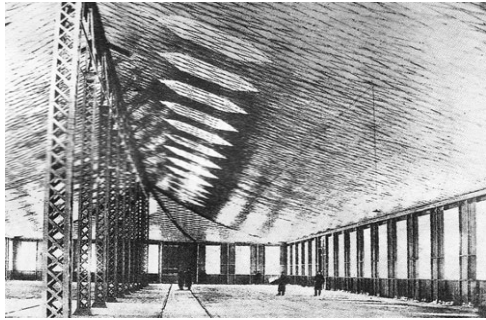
Конструкция висячего покрытия прямоугольного в плане павильона. 1896г.
